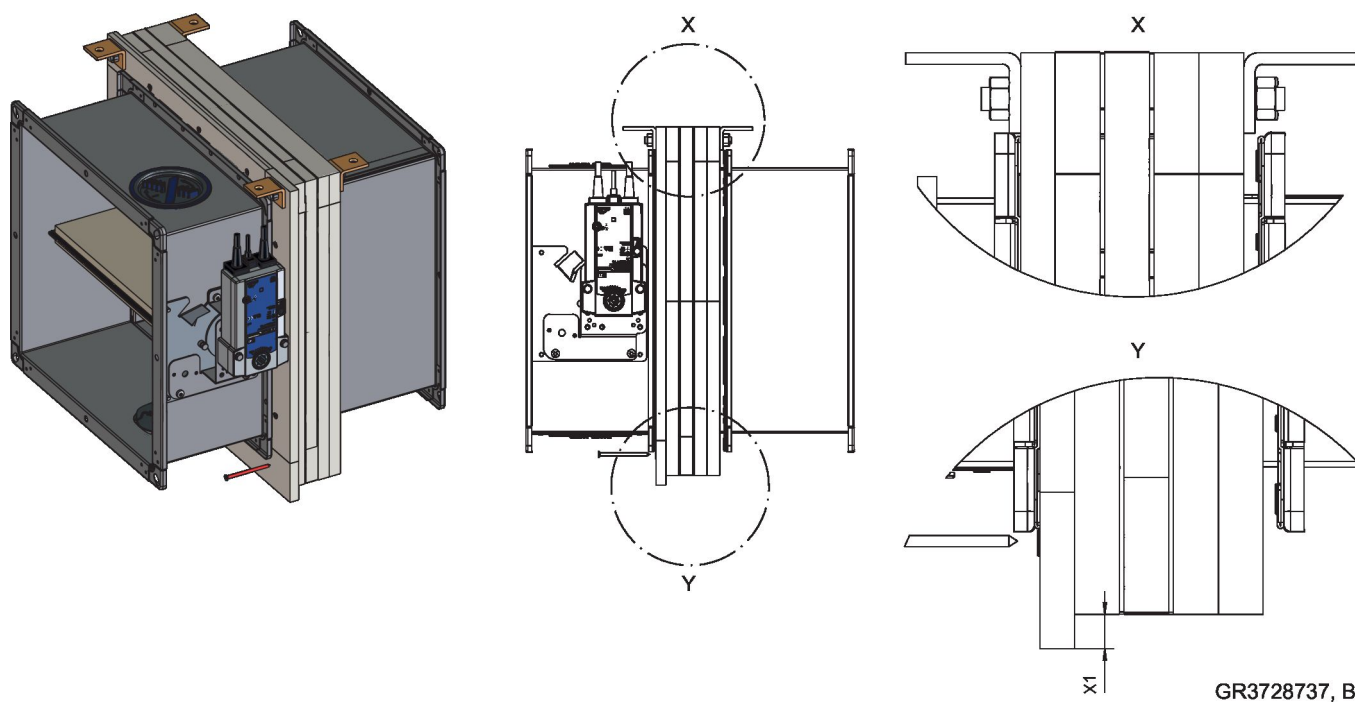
Kit GL de montage à sec sans mortier – montage après assemblage
